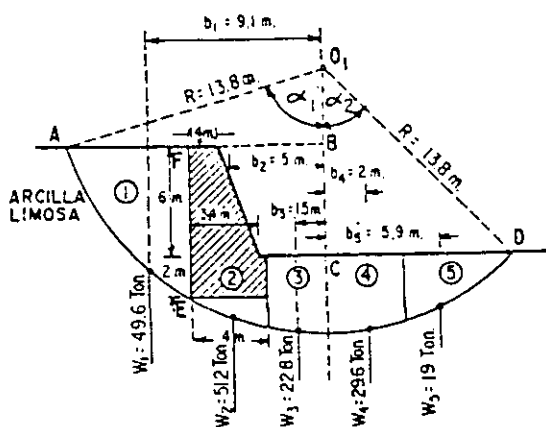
Planteamiento del problema y primer tanteo.
